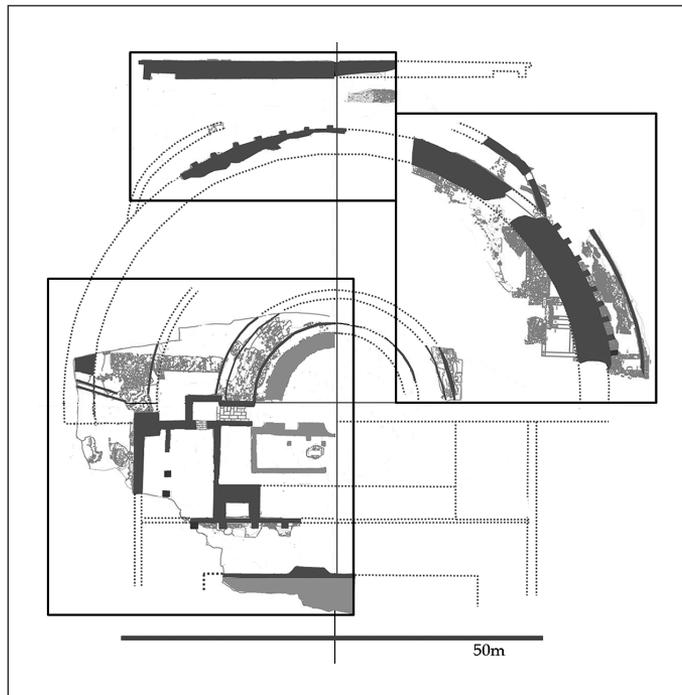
Planta restituída do teatro a partir das áreas escavadas.
